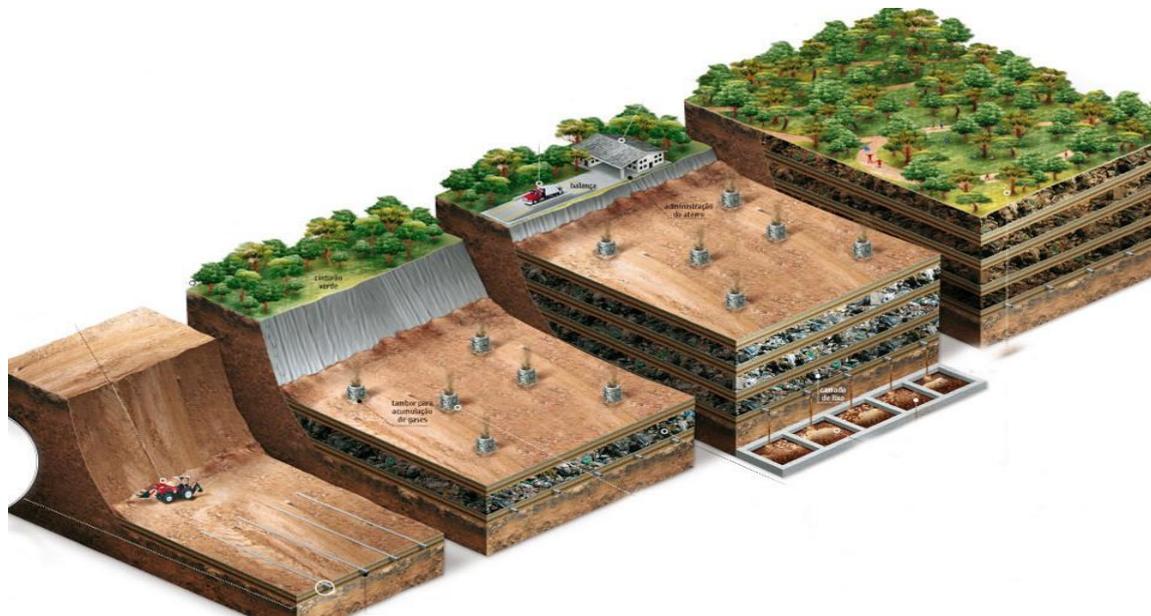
Desenho esquemático de um aterro sanitário. (Revista VEJA -2009)
